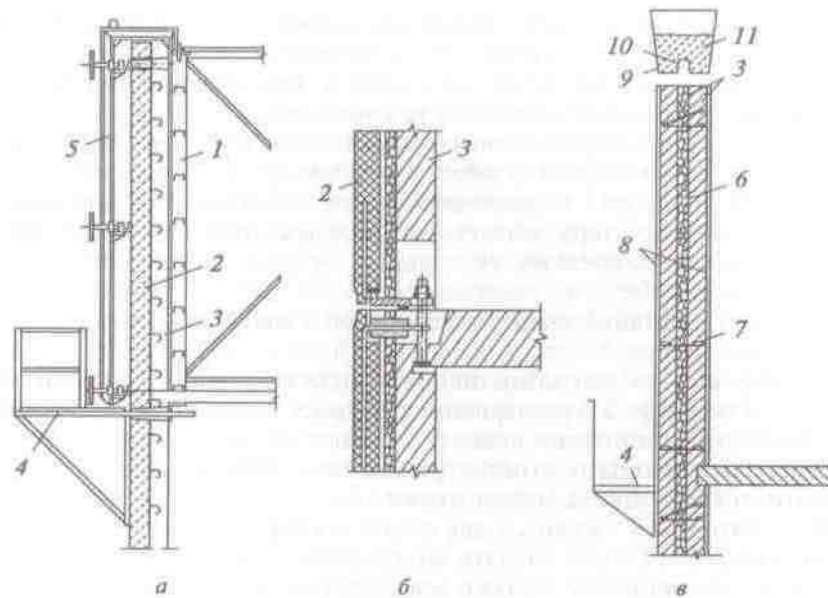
Зовнішні стіни монолітних будівель: а – двошарова; тришарова із зовнішнім шаром зі збірної панелі-шкарлупи; в – теж саме, із зовнішніми шарами з монолітного бетону; 1 – блочна опалубка; 2 – панель-шкарлупа; 3 – монолітний бетон стіни; 4 – робочі риштування; 5 – кріпильна система панелі-шкарлупи; 6 – утеплювач; 7 – в’язі; 8 – щити опалубки; 9 – баддя; 10 – розсікач; 11 – бетон
